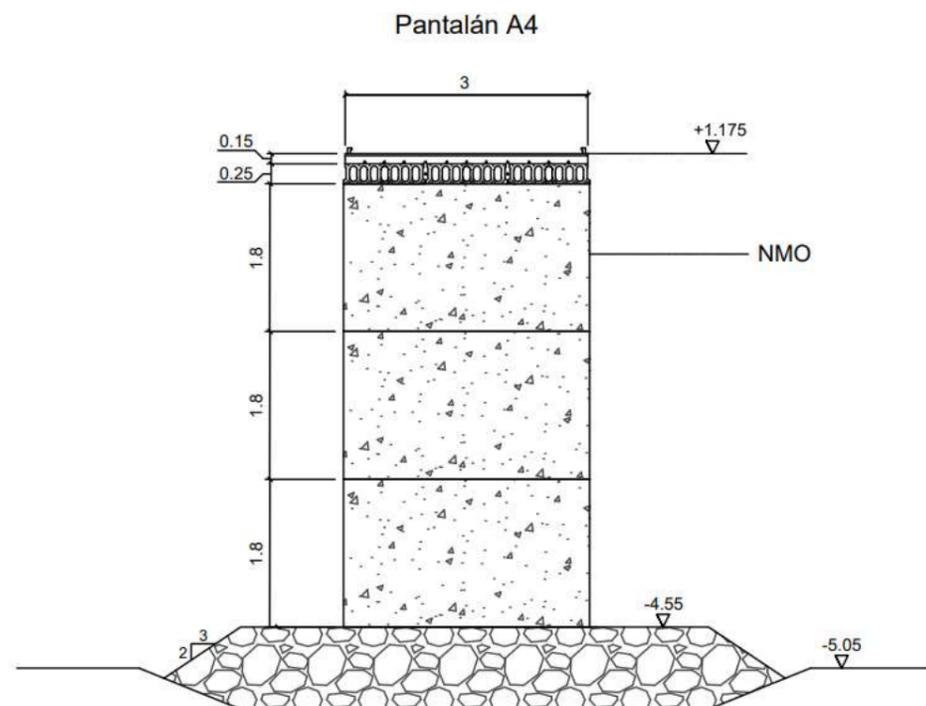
Sección transversal pilas pantalán A4. Fuente: Elaboración propia.
